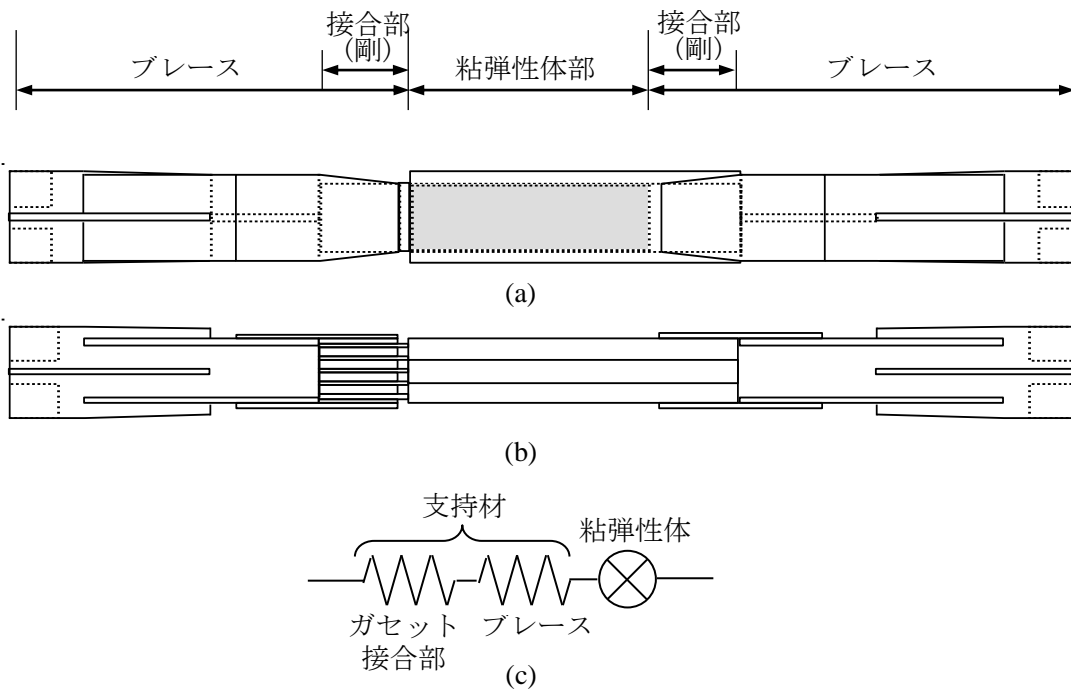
ブレース型粘弾性ダンパー (a)立面図, (b)平面図, (c)解析モデル
